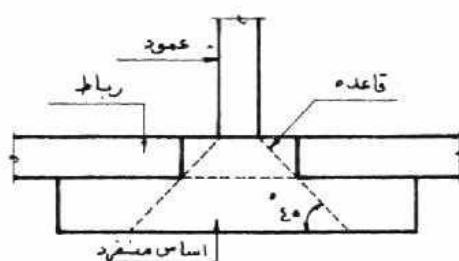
٩) مخطط وقطع أساس منفرد مع رباط من الخرسانة المسلحة
